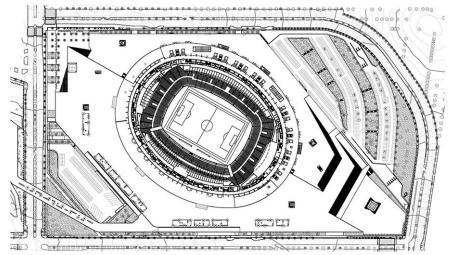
Стадион Mineirao. План 1 этажа. Эспланада. [6]
